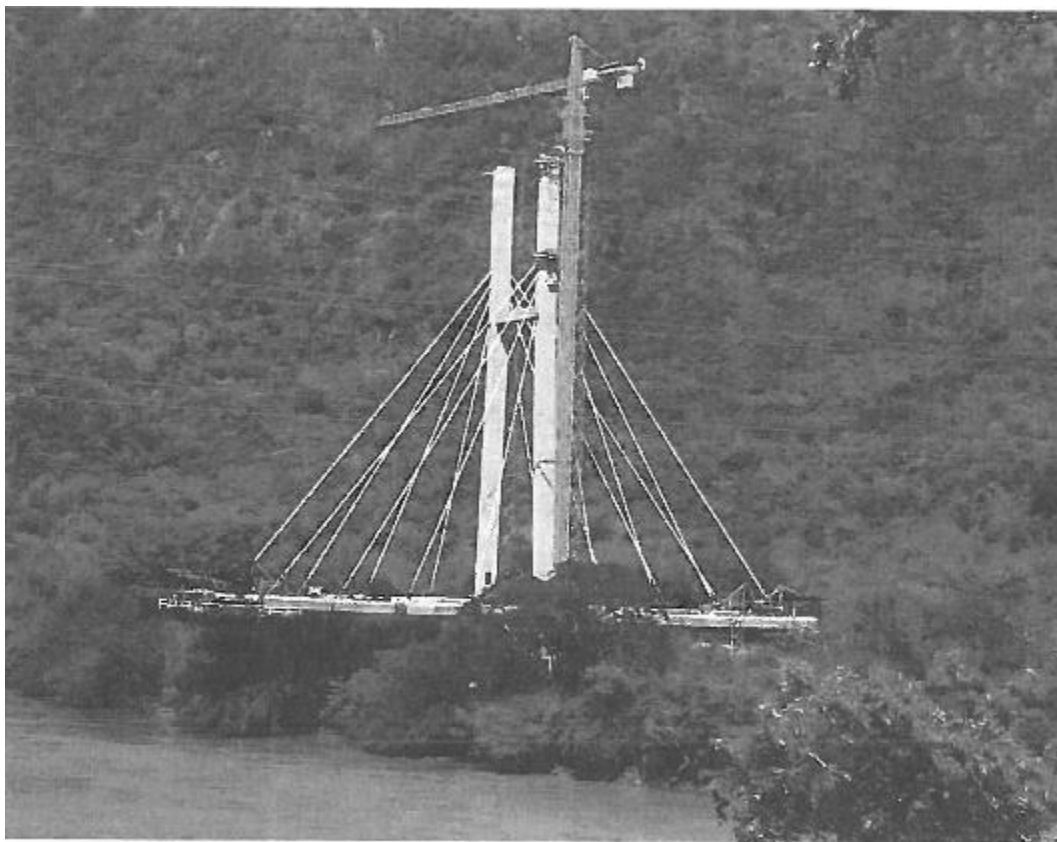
Puente Honda en construcción actualmente. (SAFE Instrumentación S.A.S, 2018)
